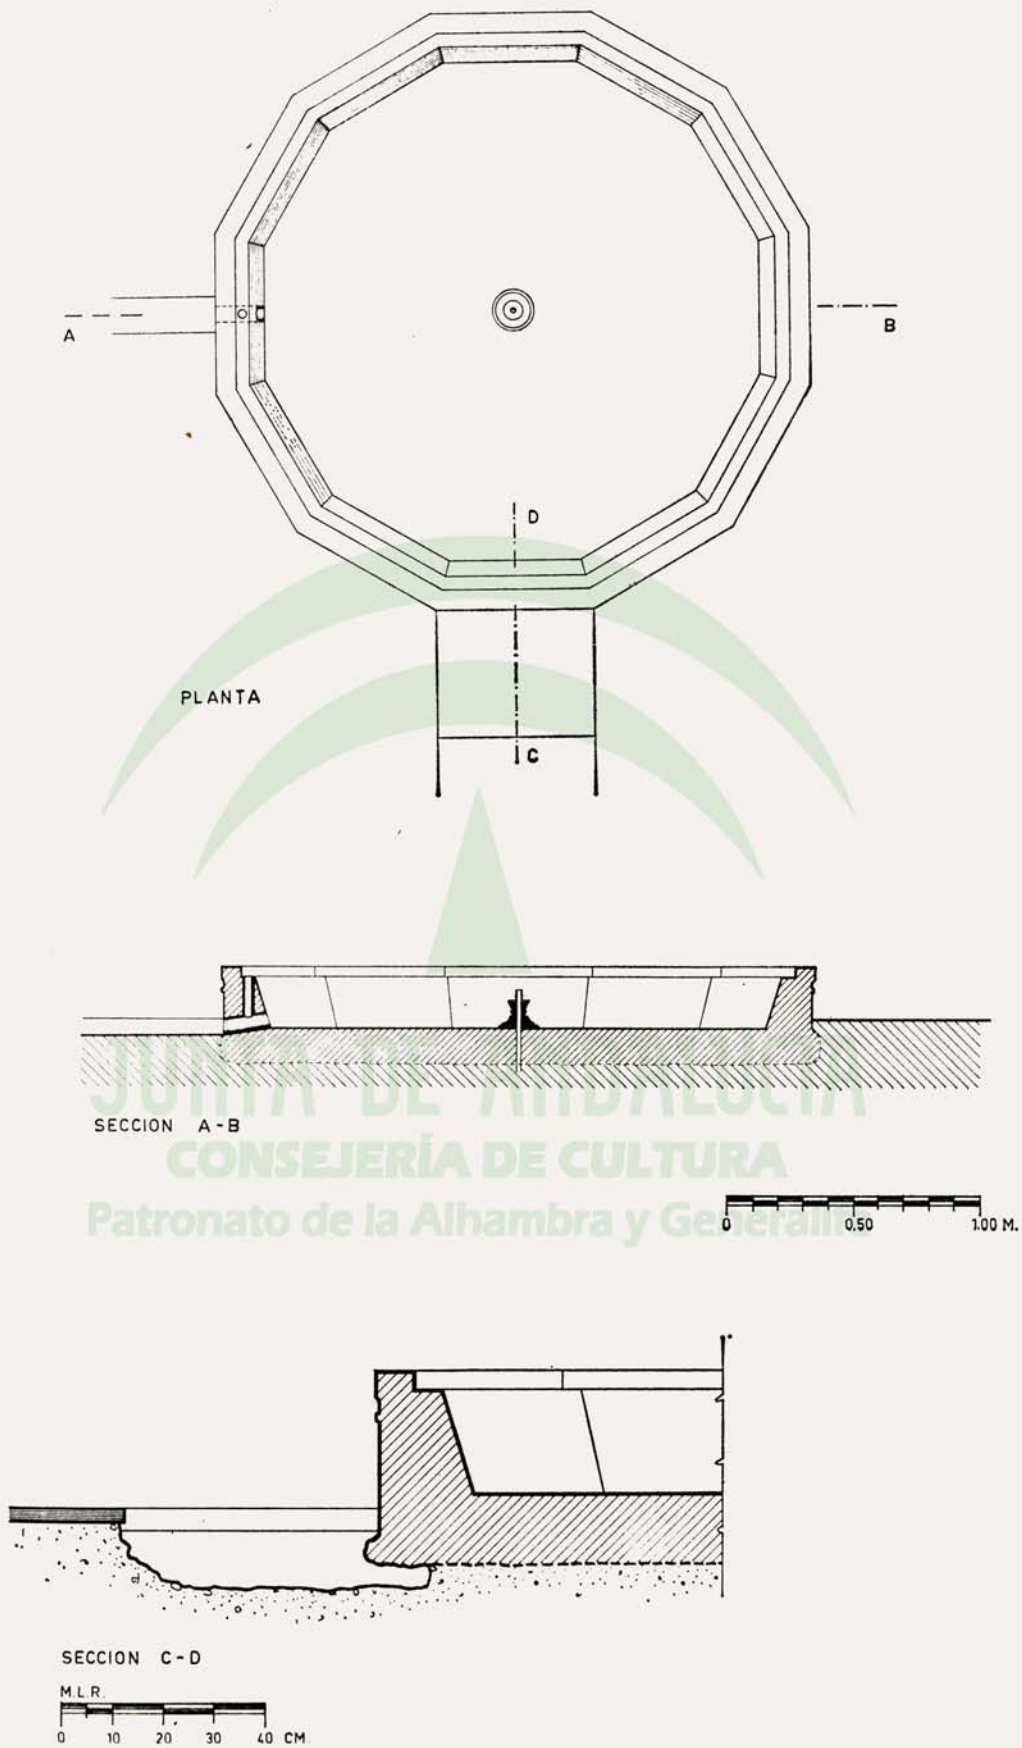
Planta y sección de la fuente de Abencerrajes
